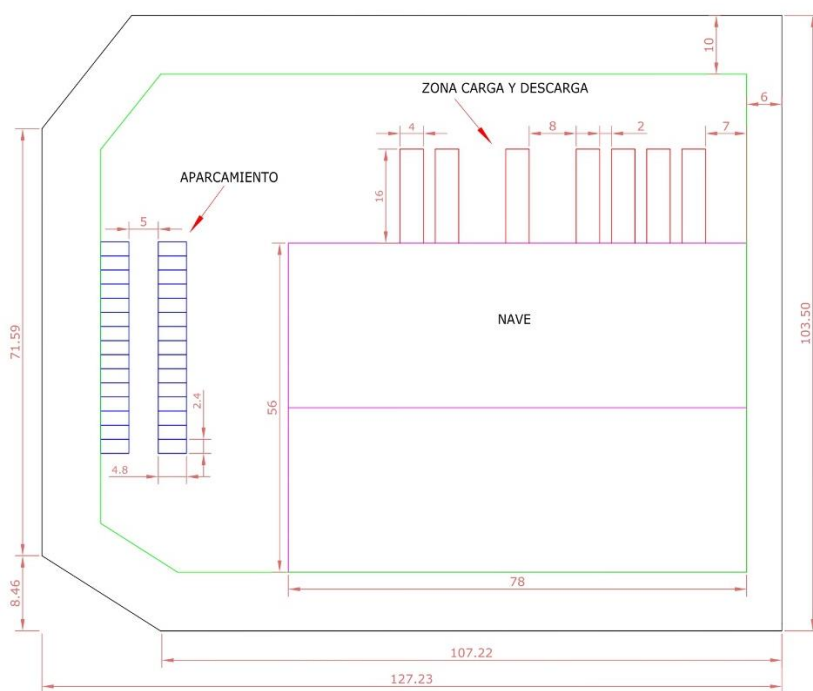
Distribución de la parcela. Fuente: Plano nº2.
